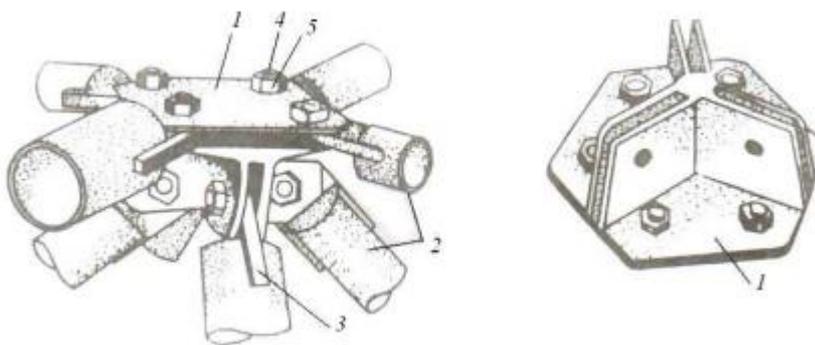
Конструкция принятого узла: 1) – узловая деталь; 2) – трубчатый стержень; 3) – наконечник трубчатого стержня; 4) – болт; 5) – гайка.
